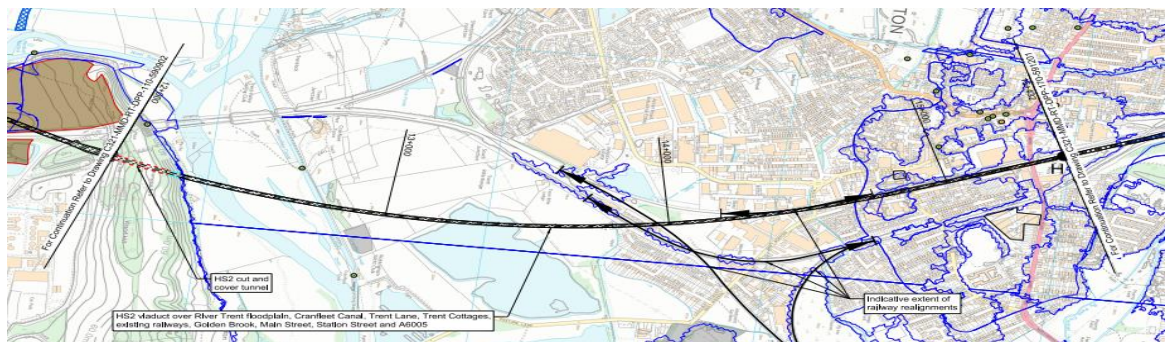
Planta do traçado viaduto sobre a bacia de cheia do Rio Trent e Cranfleet Canal (Unido, HS2 Phase 2b: Tonge to Long Eaton route sheet 2).
